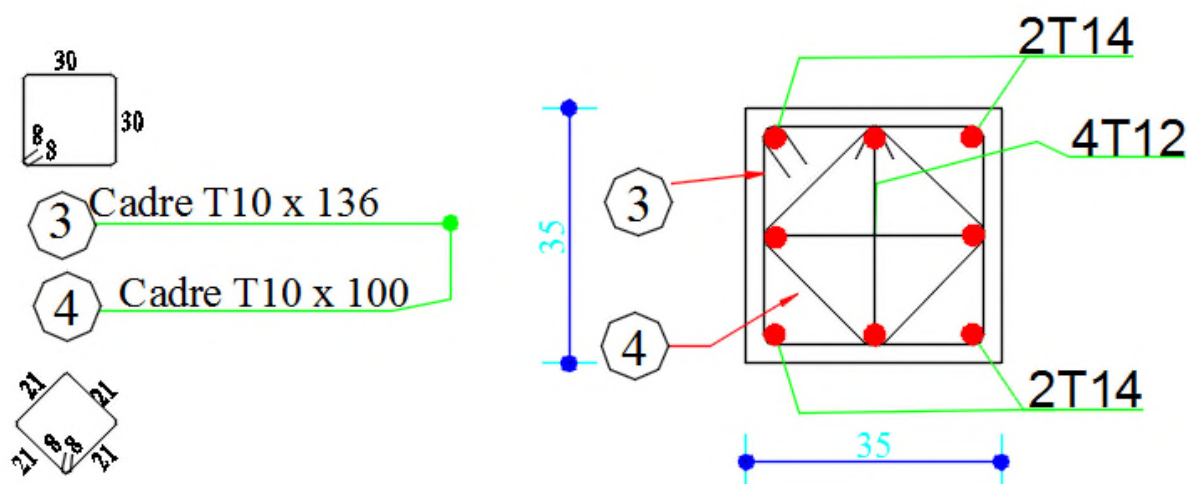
Schéma de ferrailage des poteaux^{8^{ème}}
